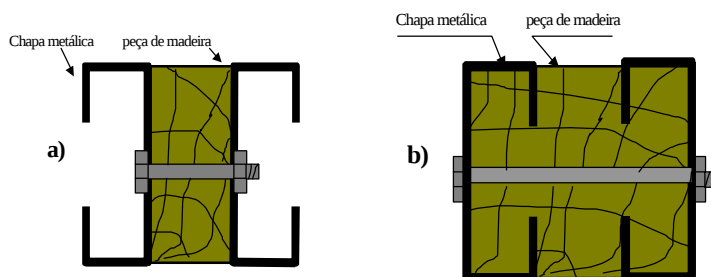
(Arranjos de vigas leves utilizados em cimbramentos).
